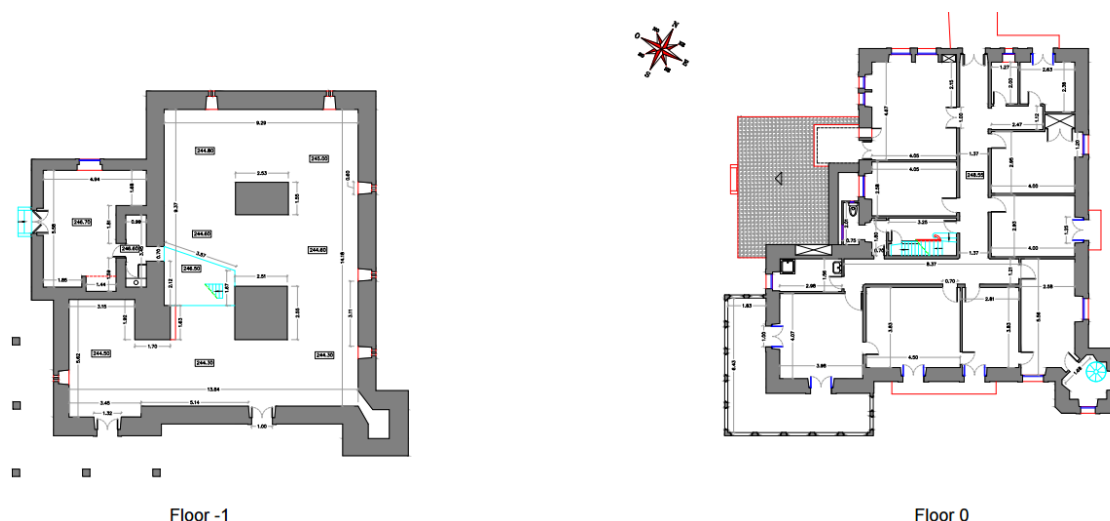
Plantas arquitetónicas do edifício: pisos -1 e 0
